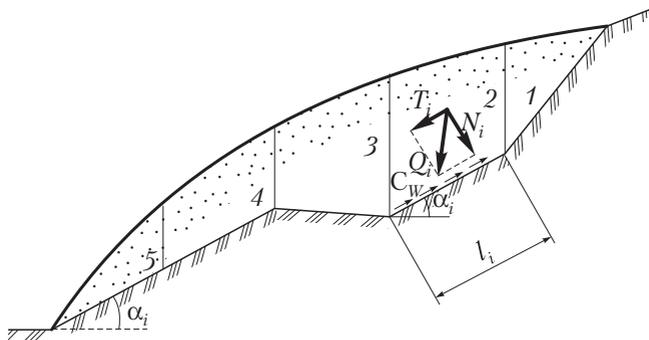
Расчетная схема к определению устойчивости склона методом ППС:
